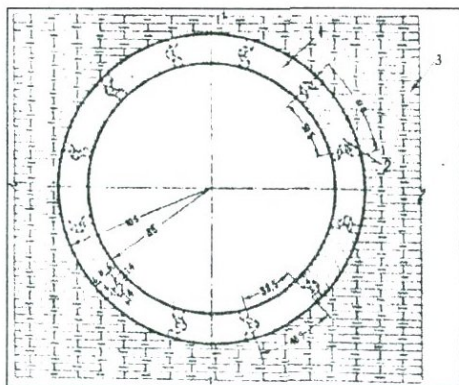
Дренажная галерея с обделкой из бетонных блоков со вставками из пористого бетона (разрез):
